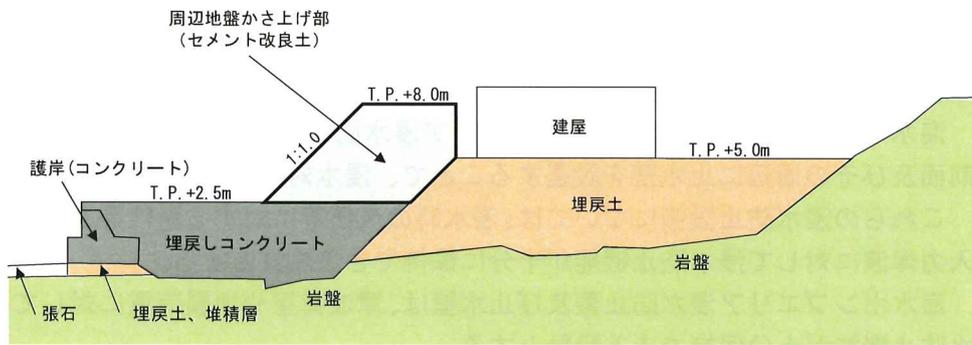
周辺地盤かさ上げ部断面図 (⑤-⑤断面)
